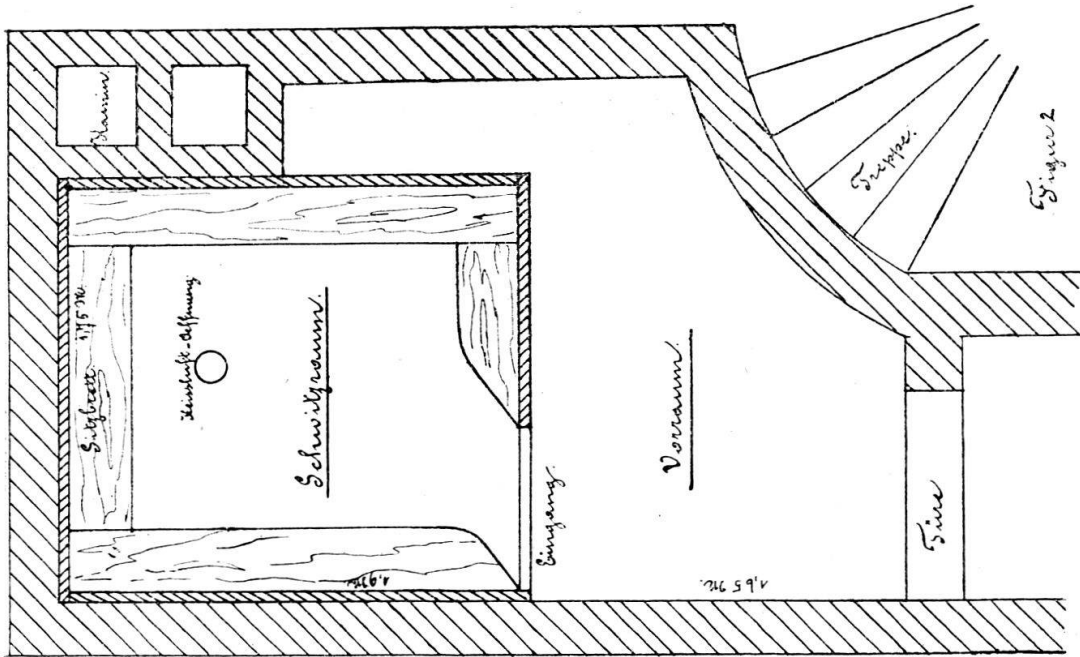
Grundriss einer zweiten Schwitzstube in Adetswil.
